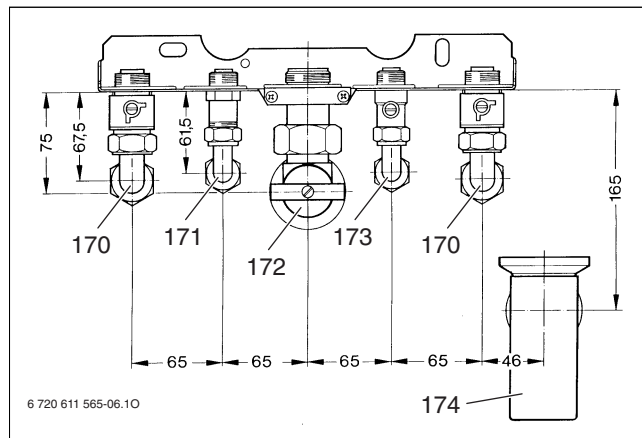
Piastra di allacciamento e montaggio con installazione sotto intonaco (installata)
